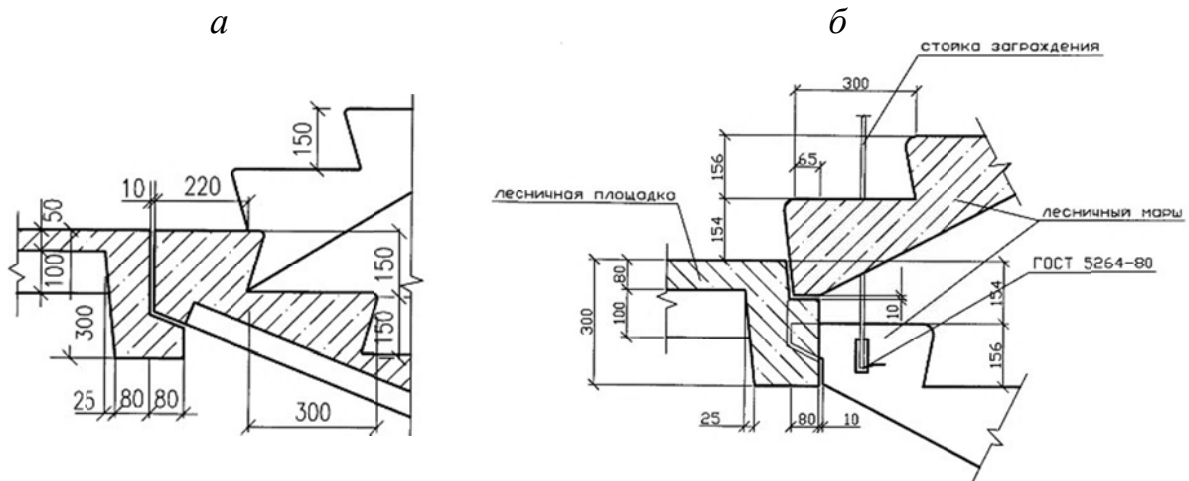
Узлы сопряжения сборной железобетонной лестничной площадки и сборного железобетонного лестничного марша ребристой (а) и плитной (б) конструкции
